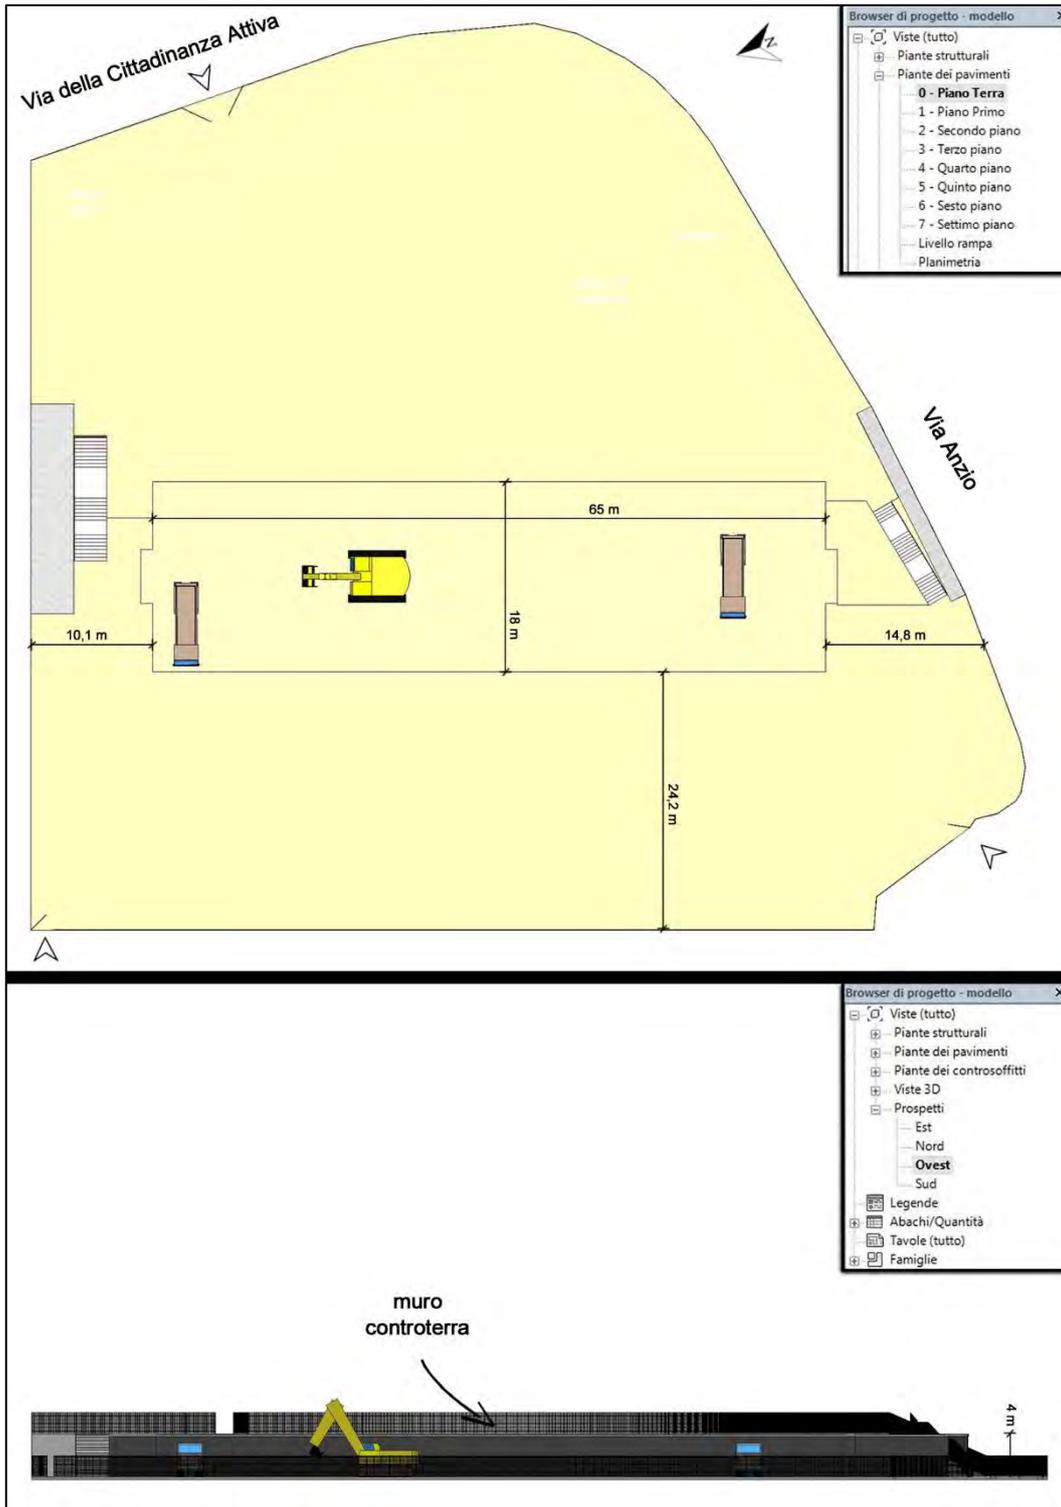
Planimetria e prospetto della fase iniziale di scavo
